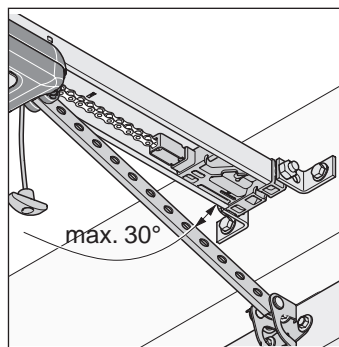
Najwyższy punkt przesuwu bramy segmentowej
